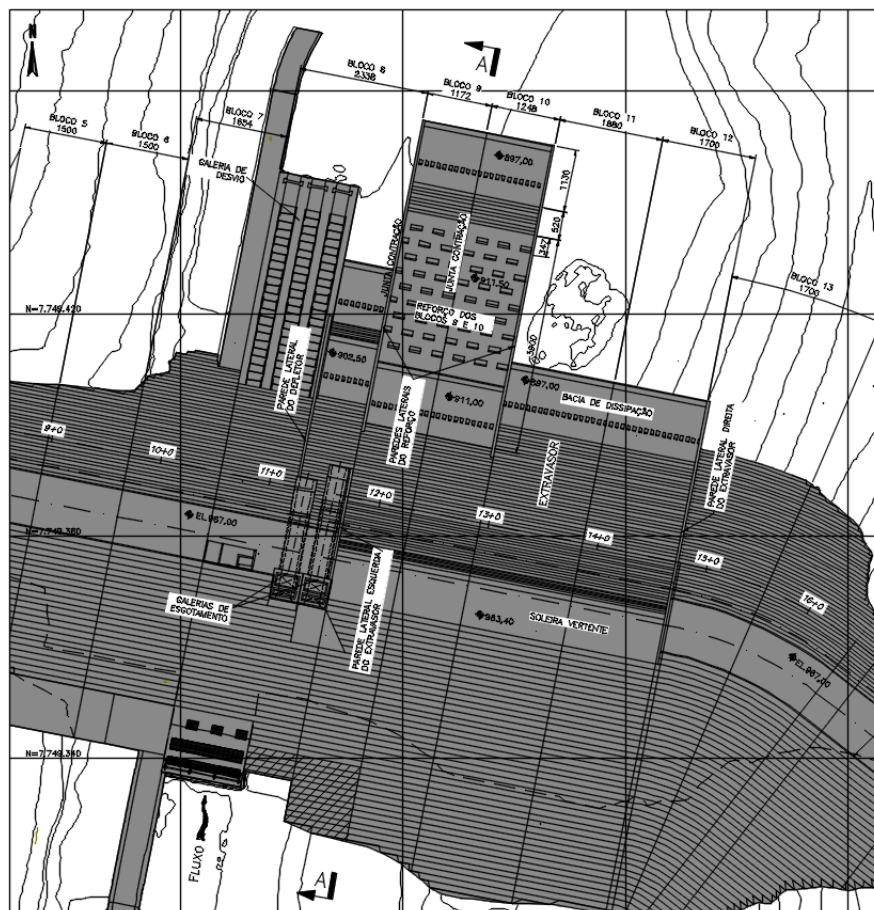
Planta com detalhe do reforço dos blocos 9 e 10, a jusante da estrutura (DF+, 2021)
